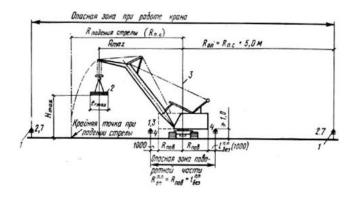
Схема назначения и расчета зон стрелового крана, не оборудованного устройством, удерживающим стрелу от падения:
